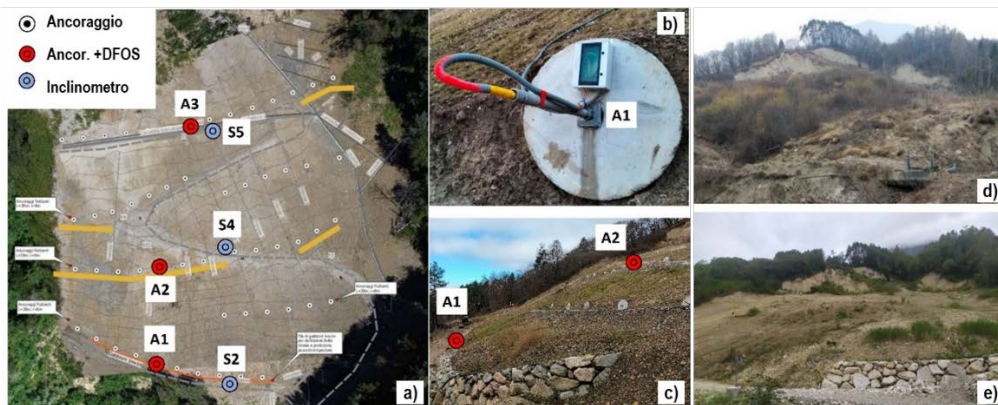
a) Vista dell'area di frana e della posizione degli interventi, dei sondaggi attrezzati con inclinometri e degli ancoraggi intelligenti; b) Piastra dell'ancoraggio A1; c) Profilo del versante dopo gli interventi; d) ed e) Vista frontale dell'area pre- e post-intervento del 2022.
